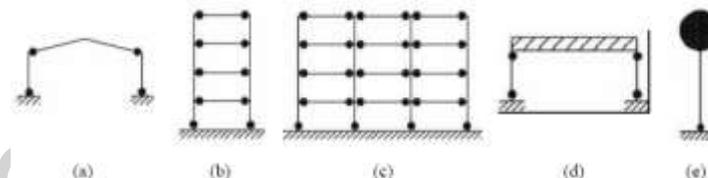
Configurazioni dissipative di strutture intelaiate: disposizione delle cerniere plastiche, secondo le tipologie esposte nella Tabella 7.3.II del § 7.3.1 delle NTC
